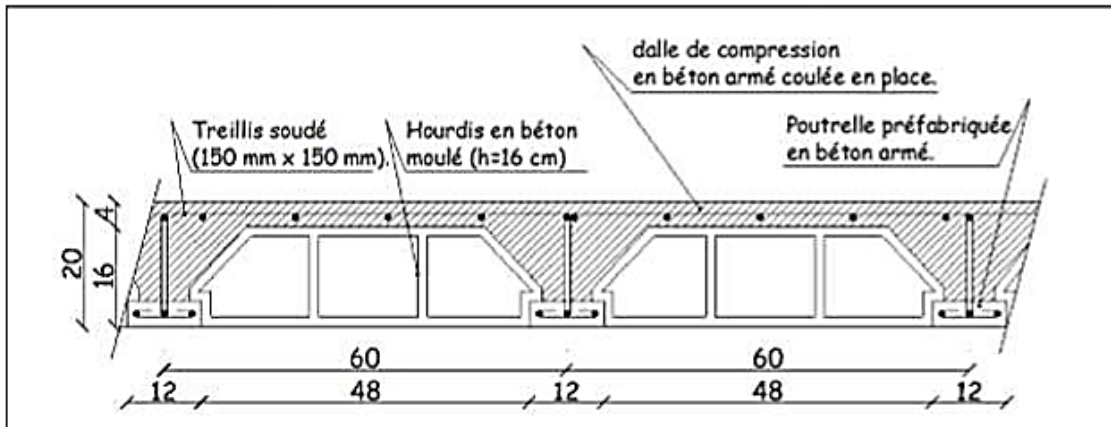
coupe transversale d'un plancher à corps creux.
